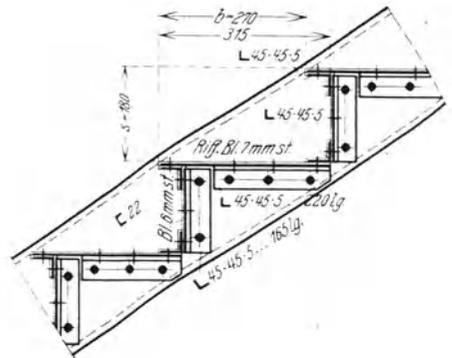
Treppe mit Tritt- und Setzstufen aus Stahl.
